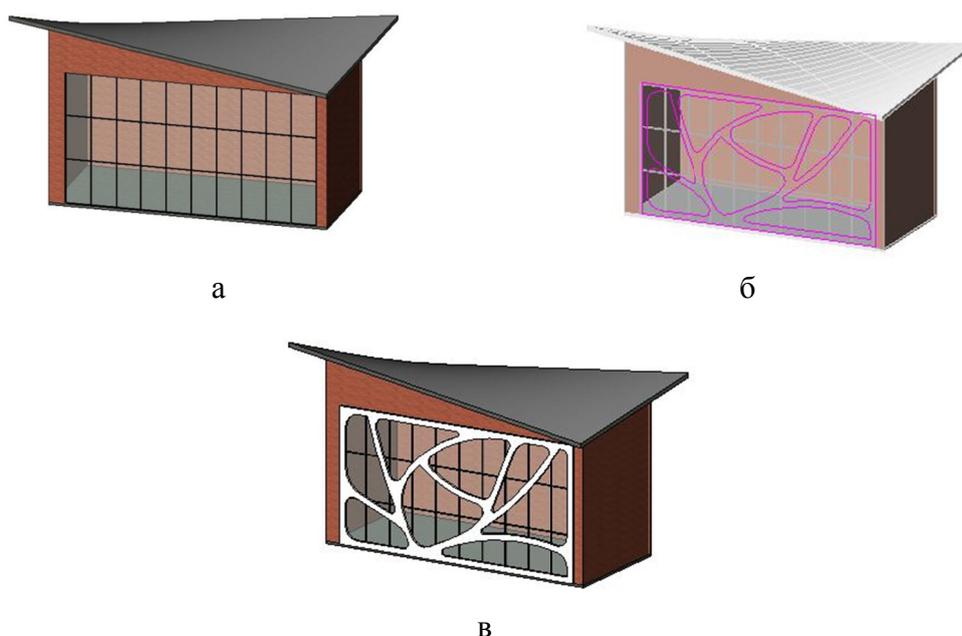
Создание фасада, «наложенного» на стеновое остекление
